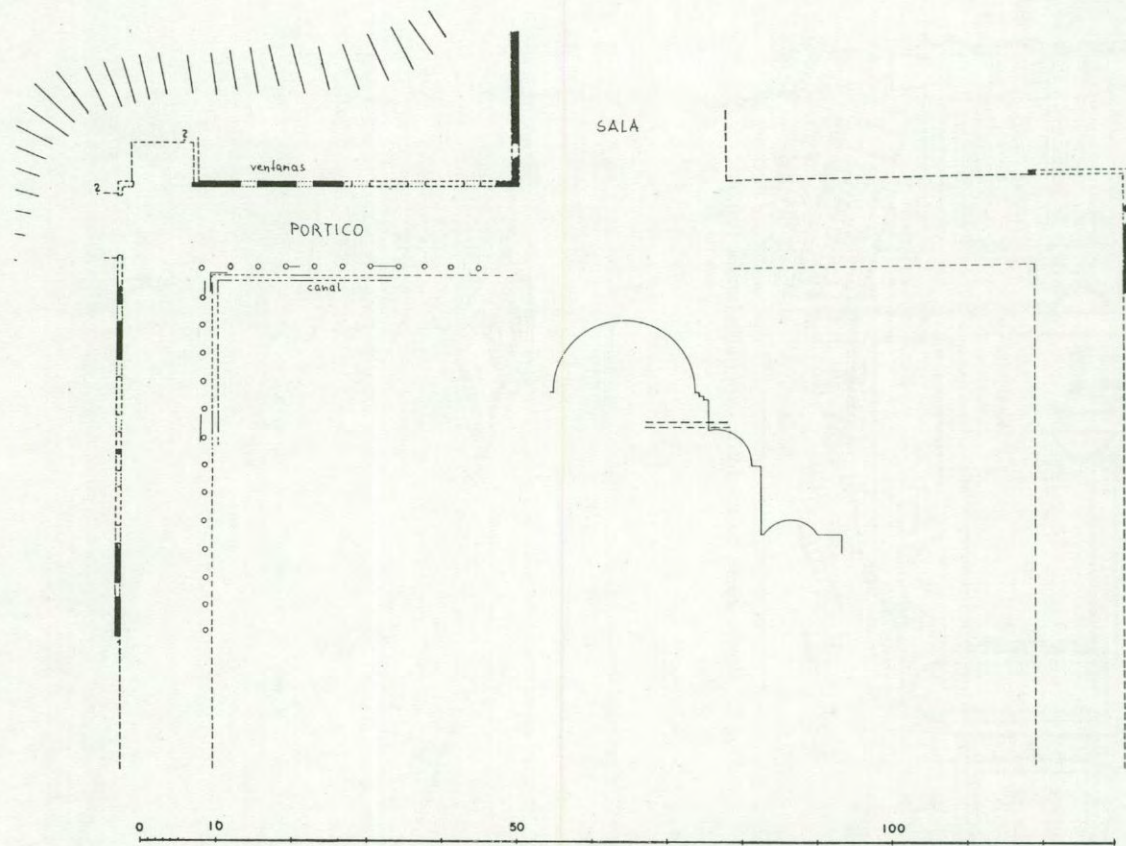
Tarragona, Catedral. Plano de las construcciones del recinto romano. La columnata está reconstruida hipotéticamente.
